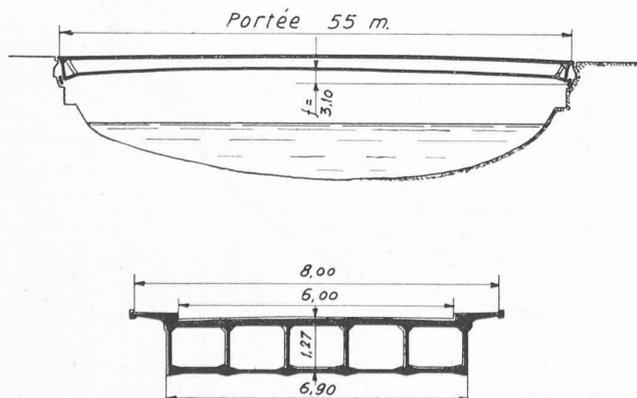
Silhouette et coupe transversale du pont de Luzancy (France) actuellement en construction.
